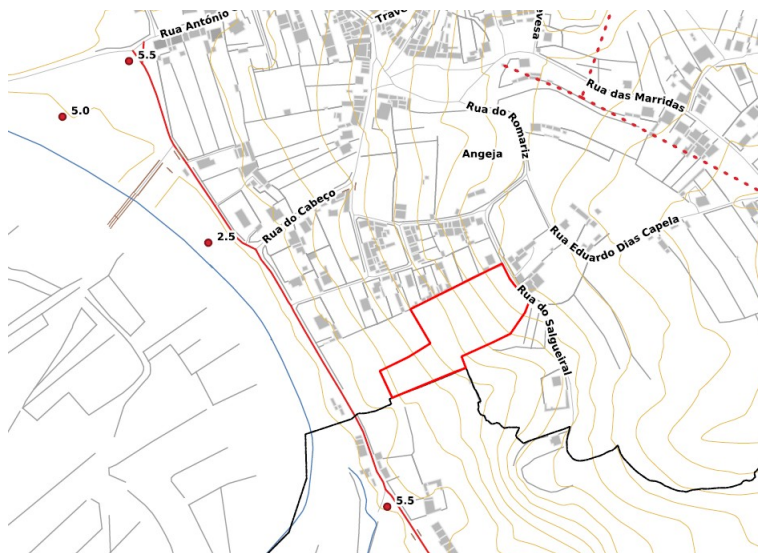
Planta de localização – Rua do Salgueiral - Angeja
